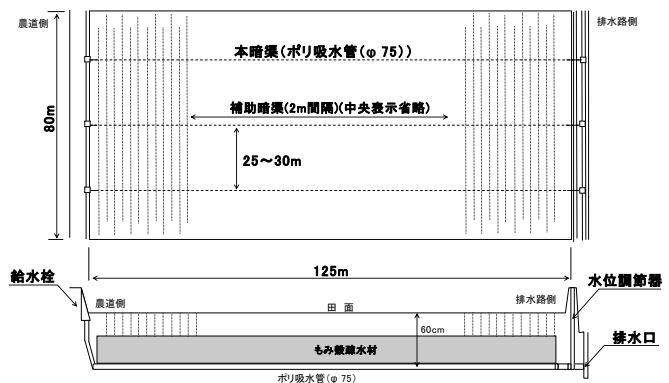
新方式暗渠の模式図(上:平面図下:縦断面図)
